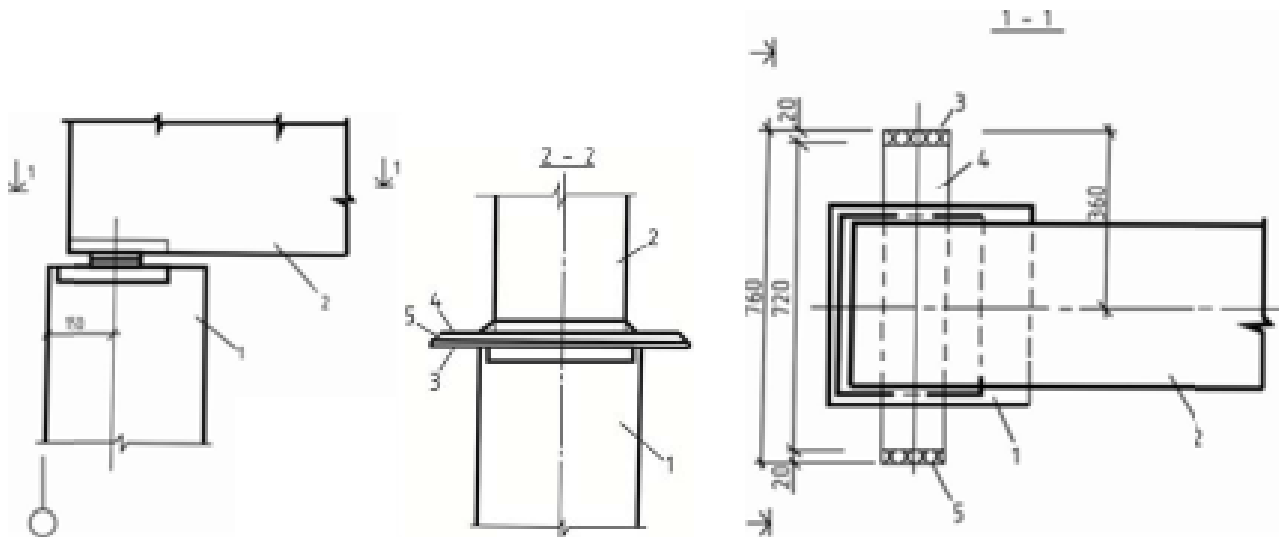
Деталь опирания стропильных конструкций на колонны при расчетной сейсмичности 9 баллов
